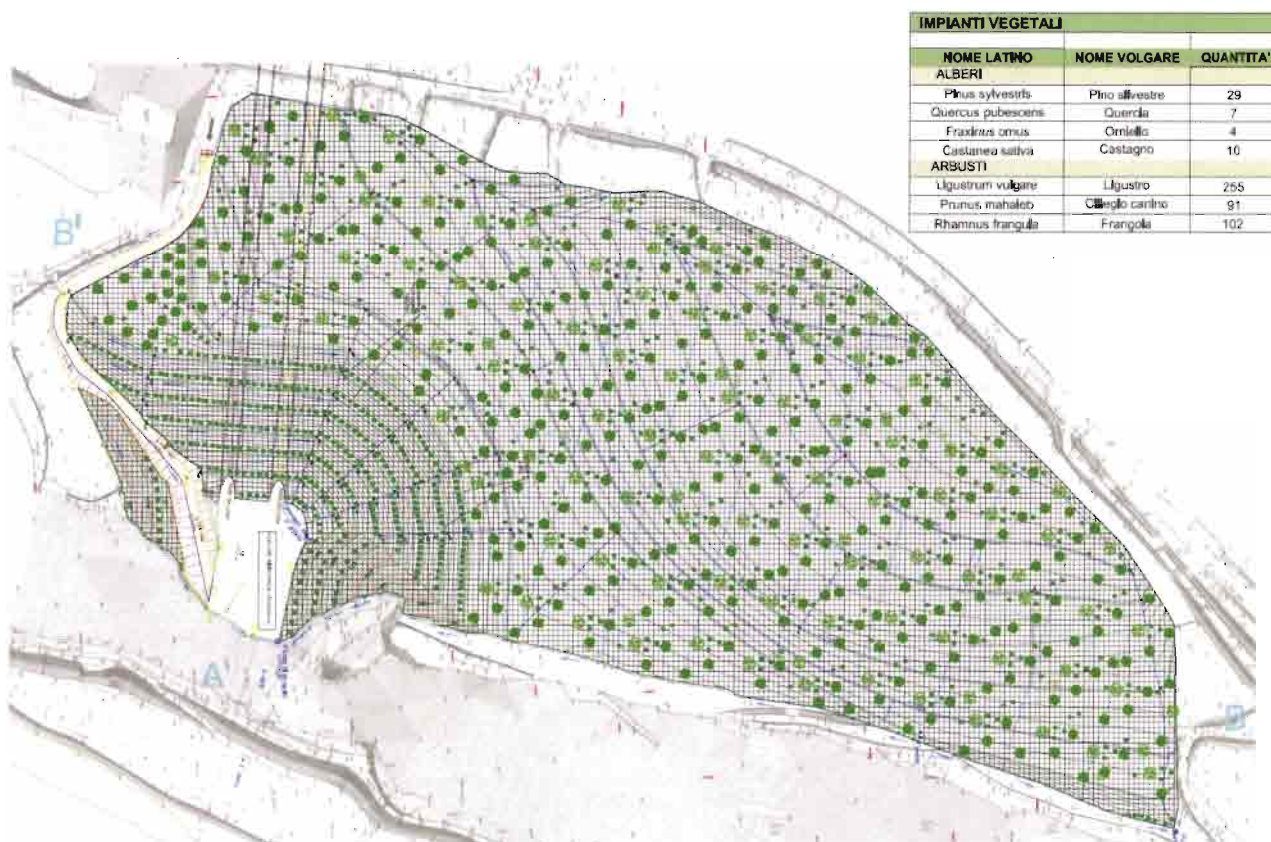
Planimetria delle opere a verde in corrispondenza del deposito definitivo Forch
